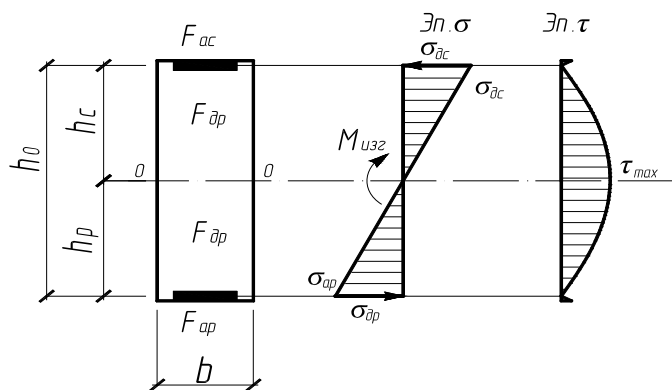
Эпюры нормальных и касательных напряжений изгибаемого элемента с двойным симметричным армированием
